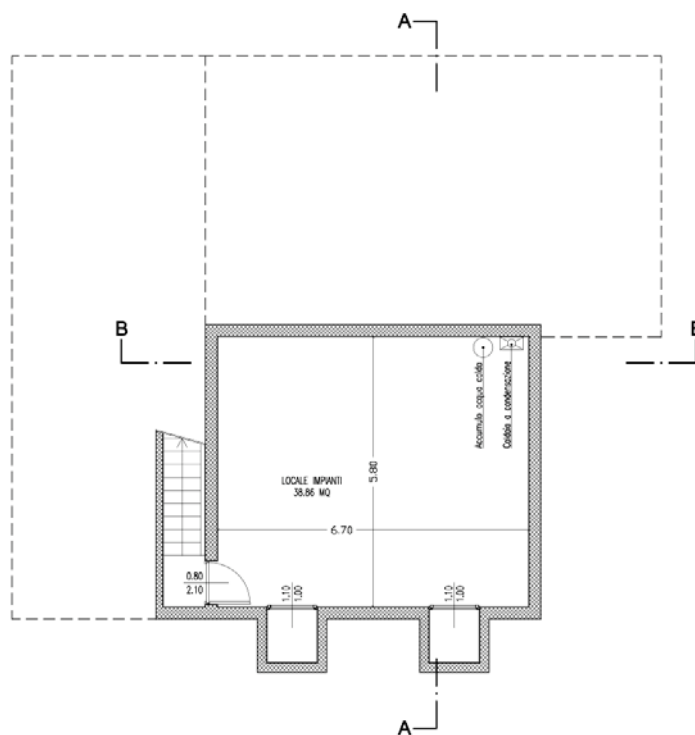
Villa singola 1: pianta interrato - archivio personale
